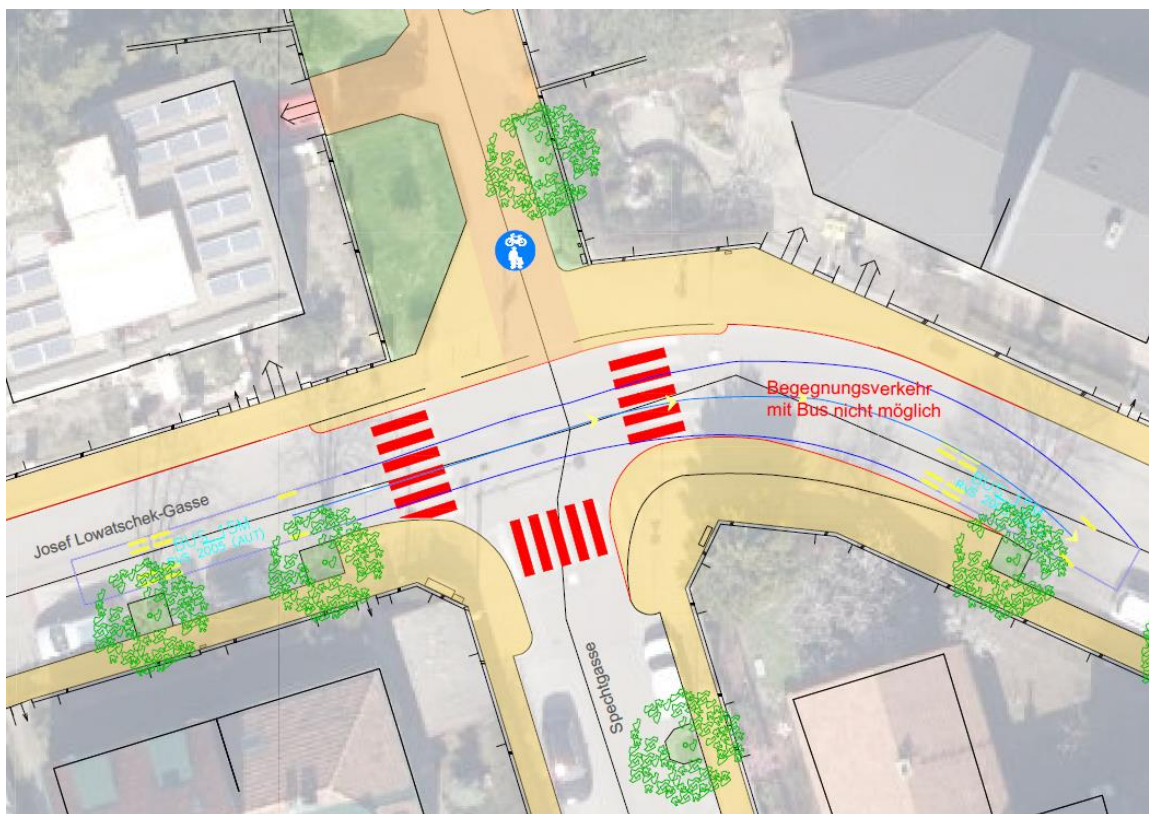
Ausschnitt Planungsvariante 1 Josef Lowatschek -Gasse # Spechtgasse
